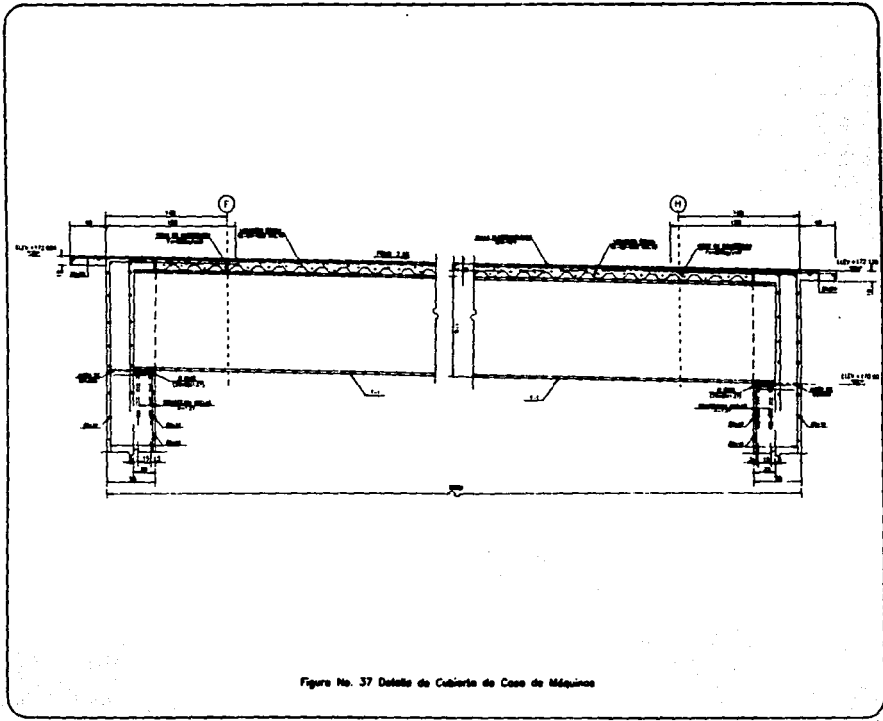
Detalle de Cubierta de Casa de Máquinas
